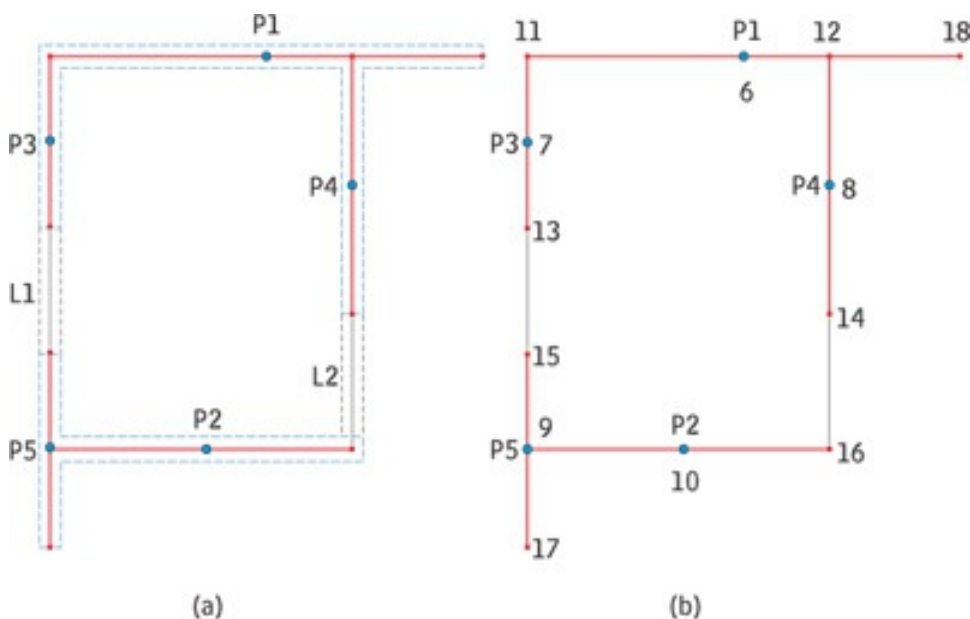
Planta baixa da modelagem dos painéis de contraventamento: (a) Definição das paredes e inclusão de lintéis, (b) Incidência das barras na modelagem
